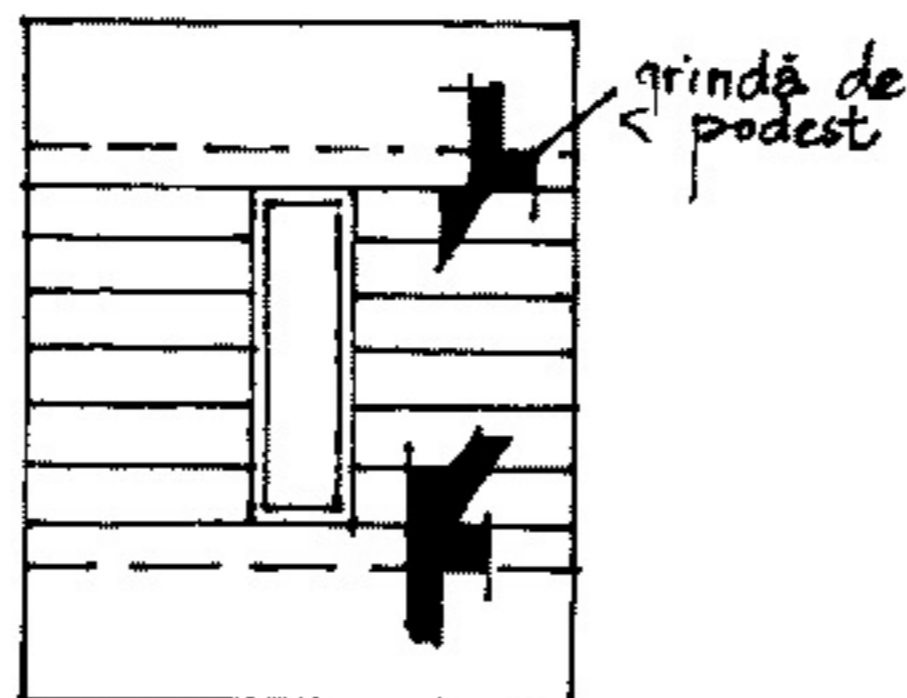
Scară din beton armat monolit cu plăci și grinzi de podest.
